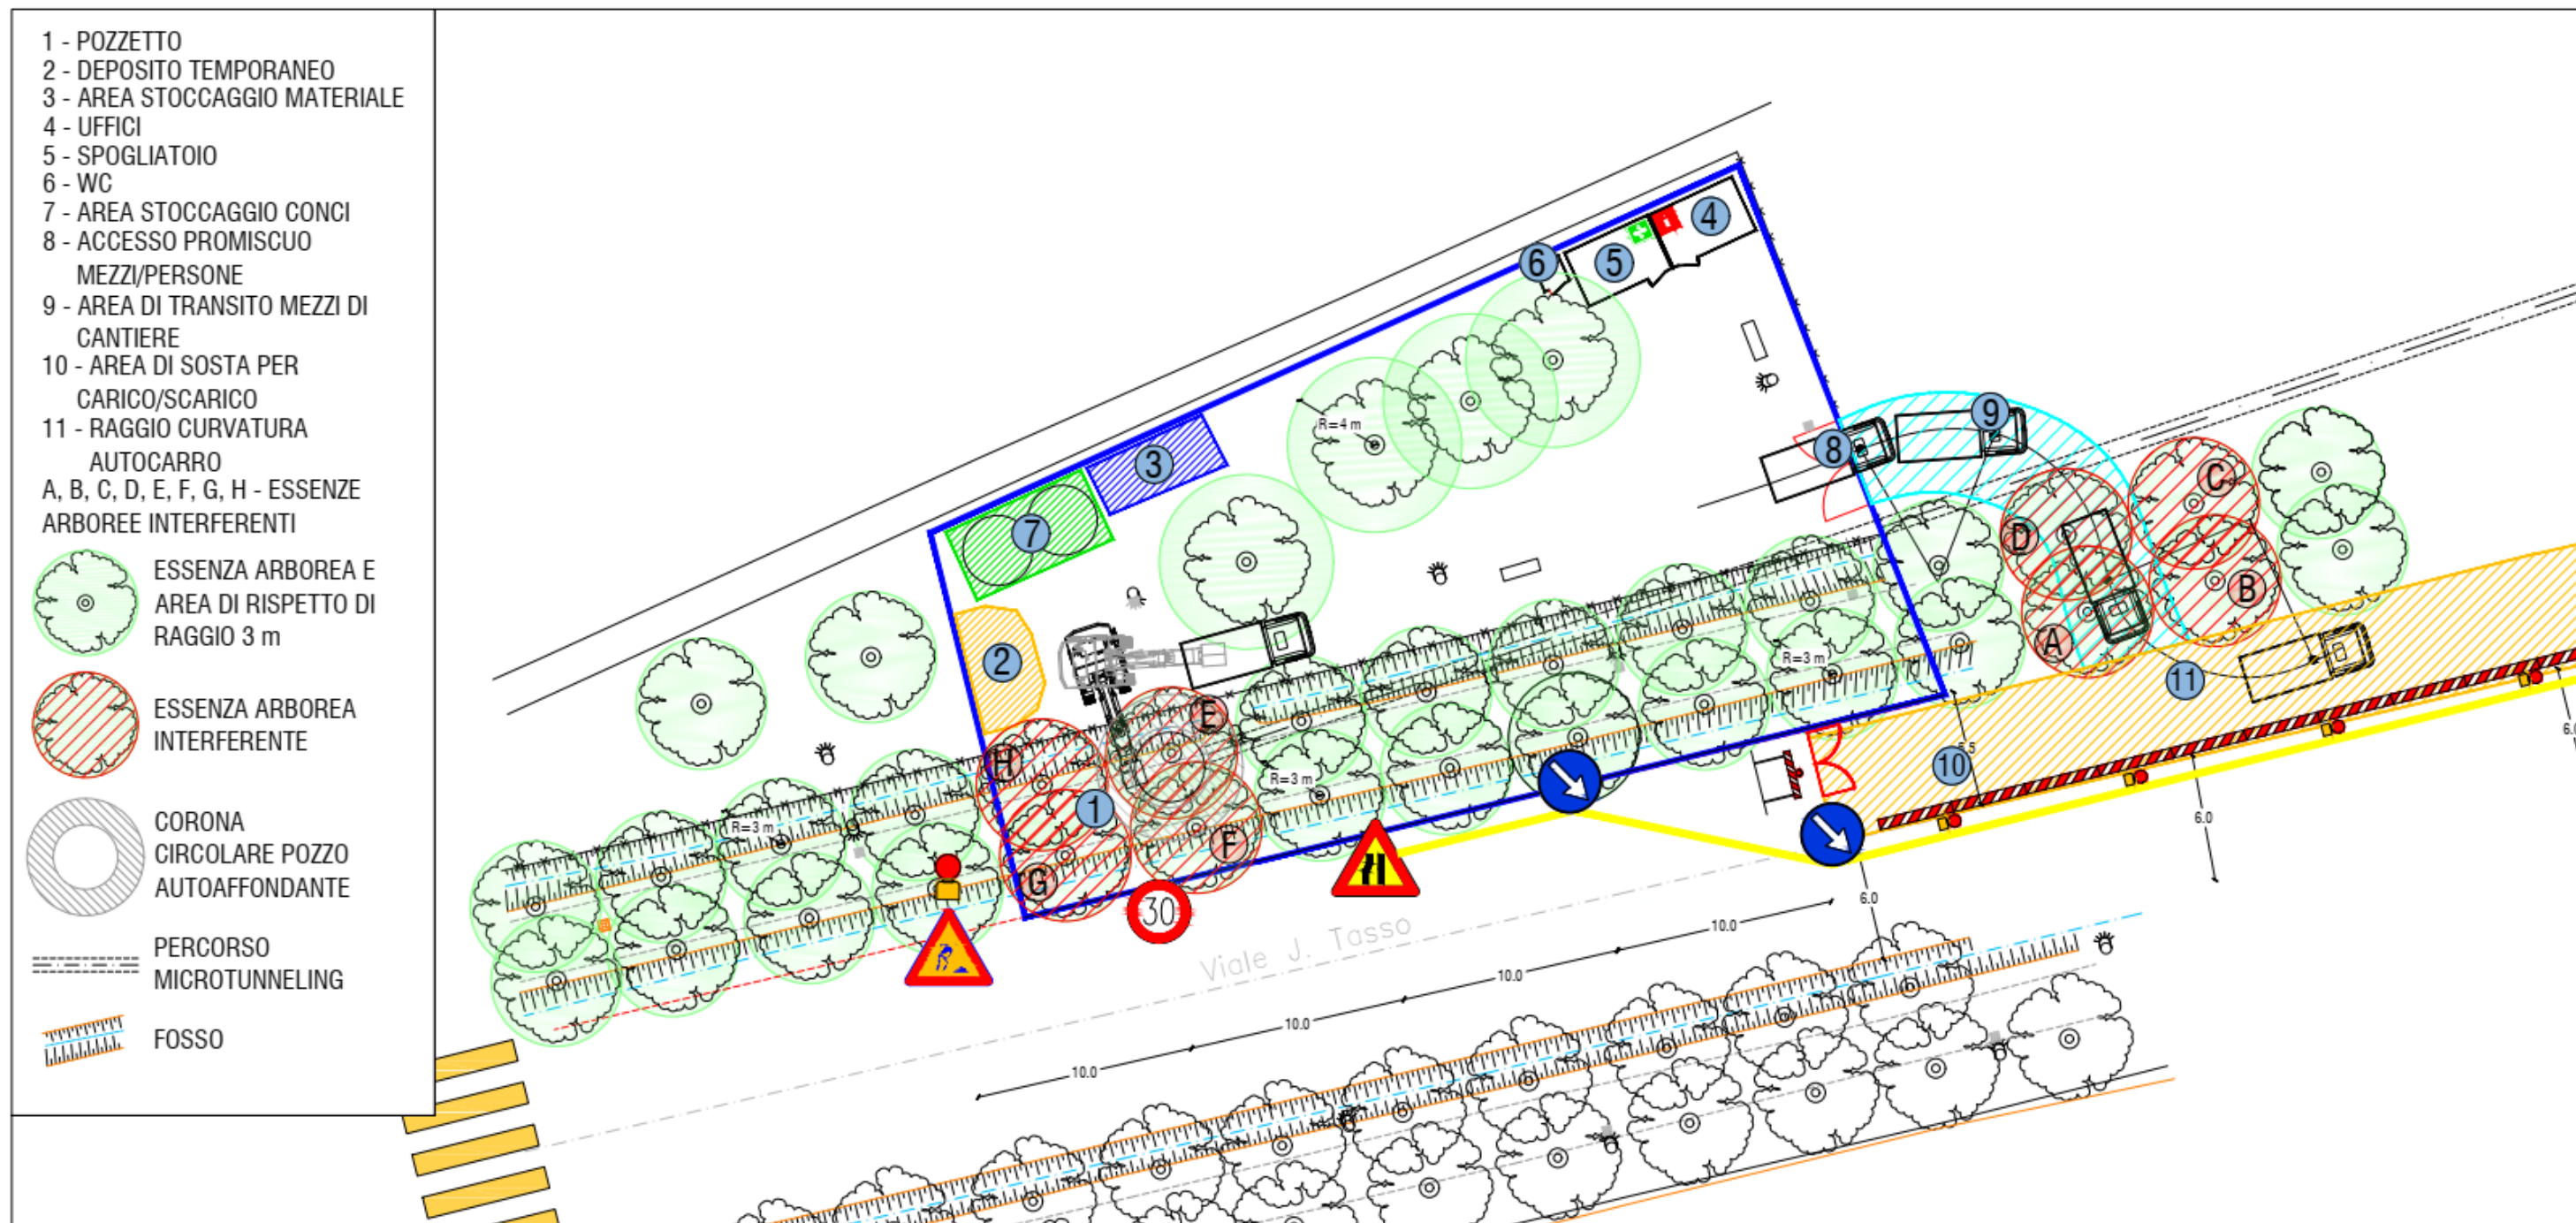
B : Inquadramento planimetrico area cantiere POZZO S03a
